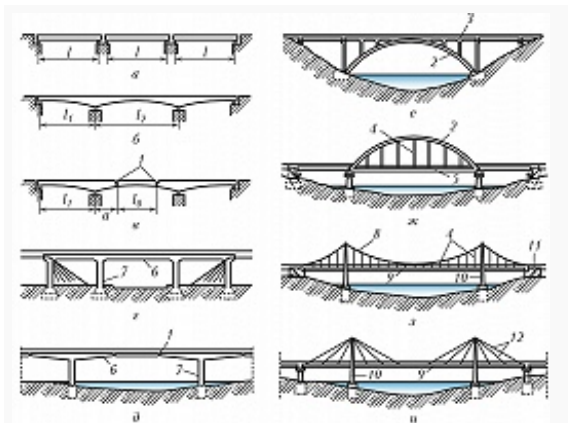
Виды мостов по статической схеме: а – балочный разрезной; б – балочный неразрезной; в – балочный консольный; г и д – рамные; е и ж – арочные; з – висячий; и...
